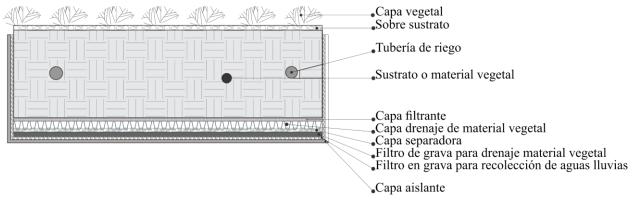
Detalle constructivo. Fuente: Elaboración propia
